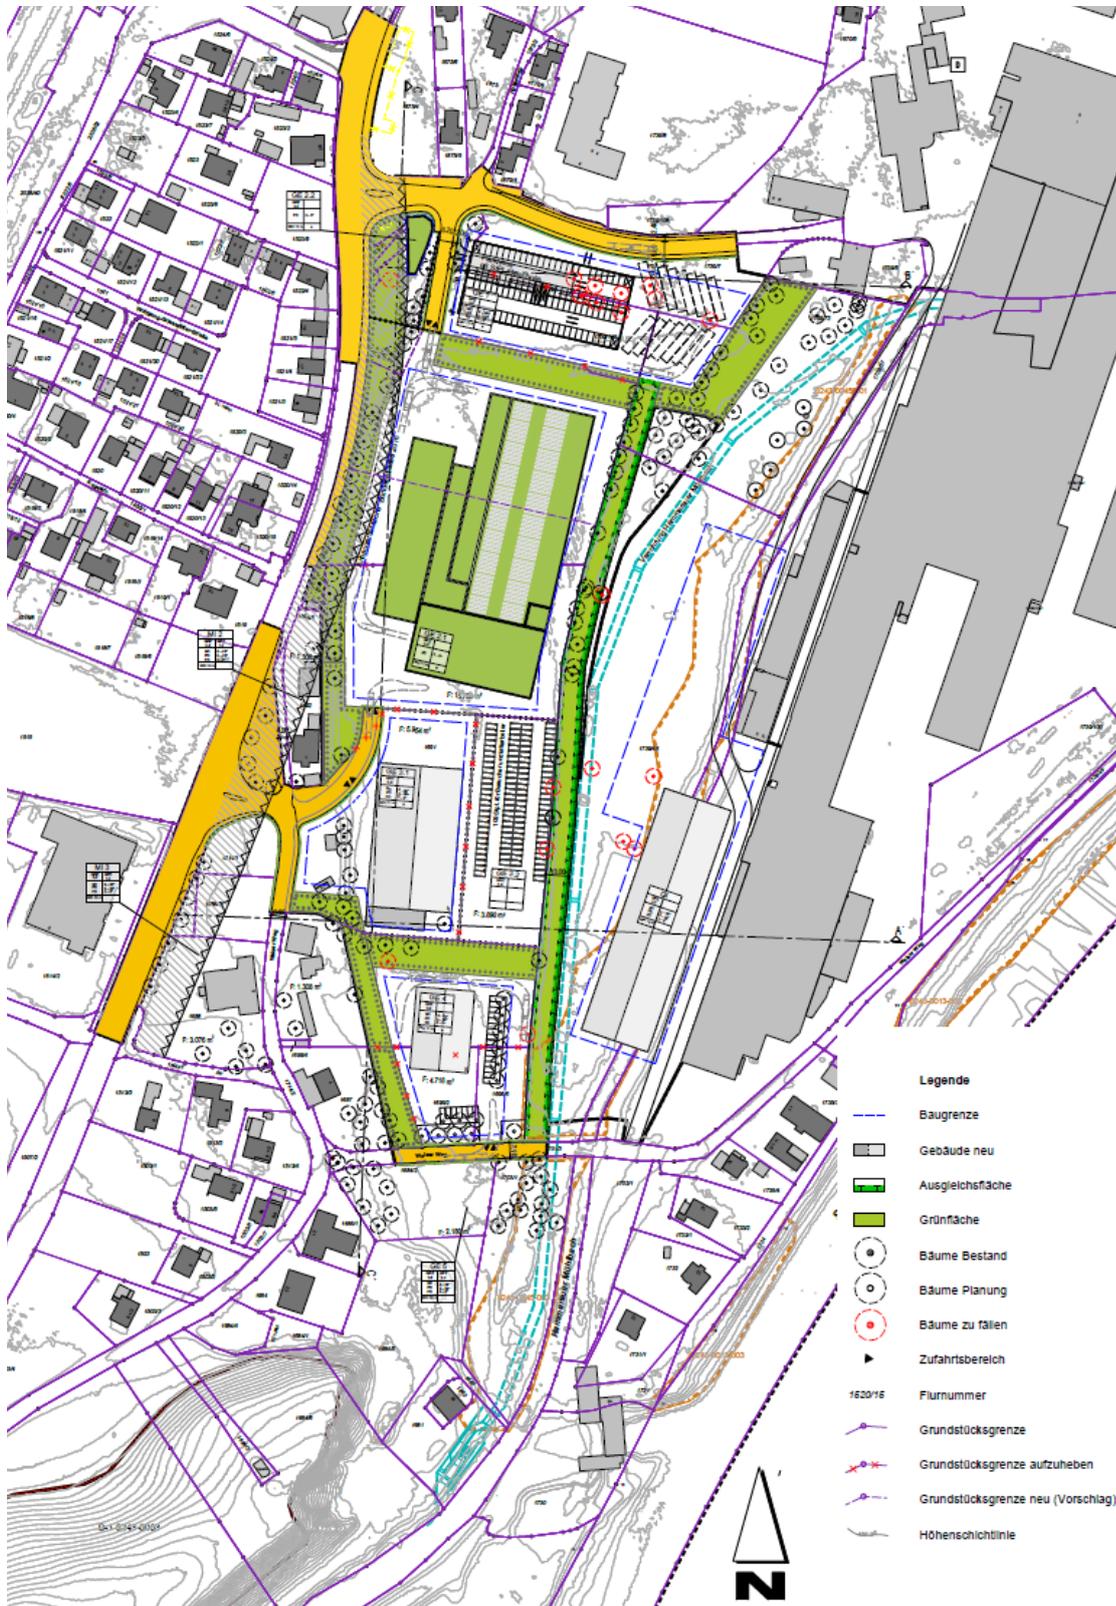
Städtebauliches Konzept „Hammerau B“, Logo verde Stadtplaner und Landschaftsarchitekten GmbH
